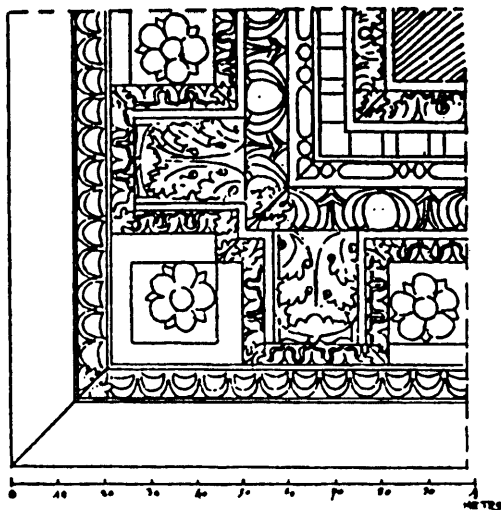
Thignica, tempio tetrastilo, cornice, prospetto dal basso (da: SALADIN).
